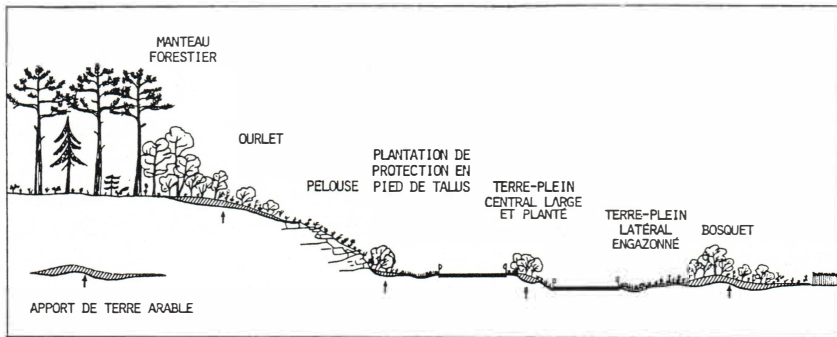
Coupe donnant la structure idéale d'un profil en travers d'une autoroute (d'après ELLENBERG *et al.*, 1981).
